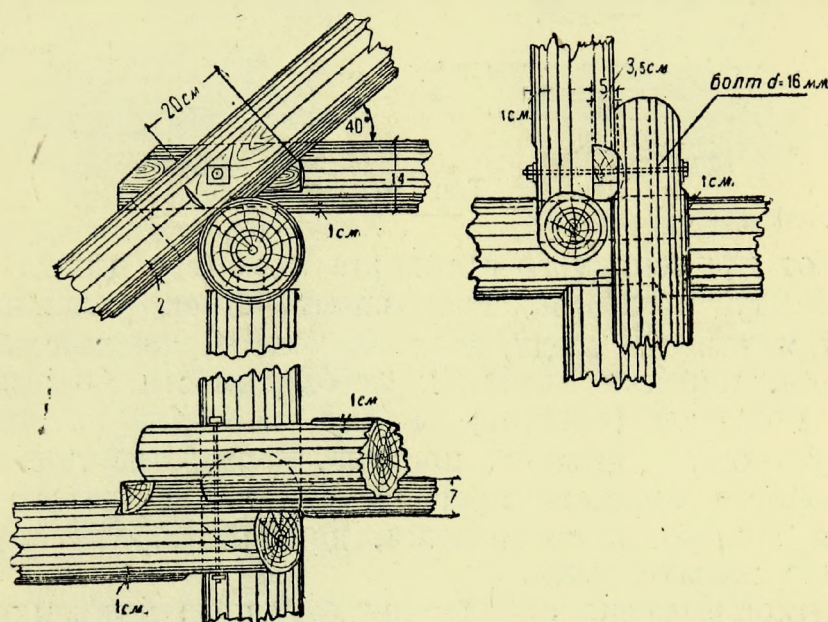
Вариант узла 2 стропил, дающий шарнирное соединение.
